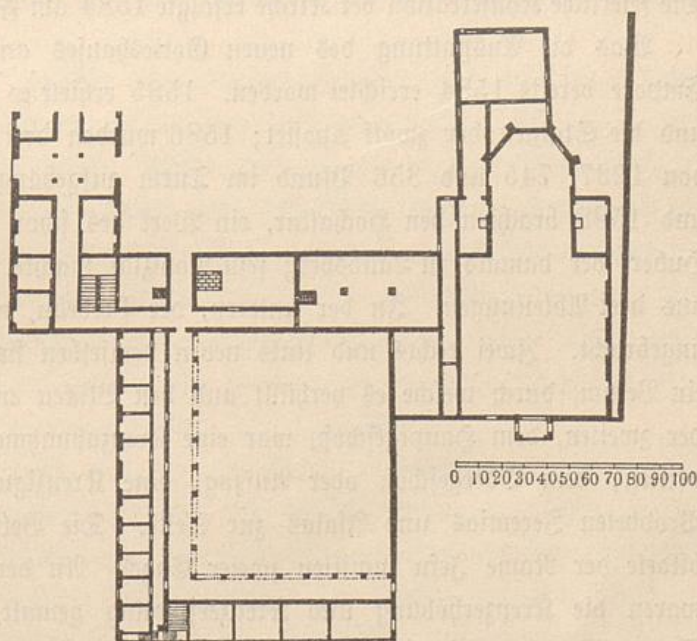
Landsberg. Kolleg mit Kirche. Grundriß.
